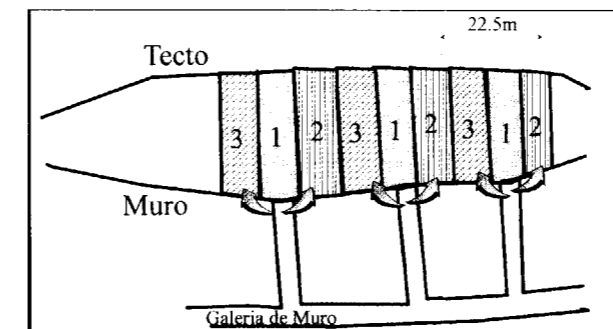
Método de Desmonte Drift and Fill Transversal - Planta
